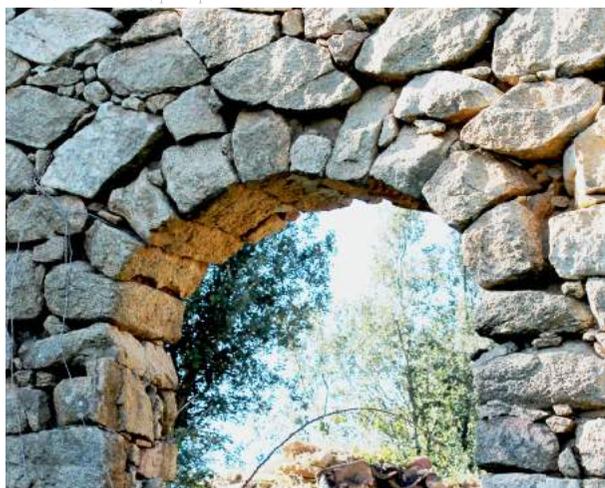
AA Particolare dell'Apertura con Arco Lapideo. Si nota la geometria dell' arco a sesto ribassato e i conci d'imposta e in chiave. Porta, Edificio 3, prospetto esterno. Foto dell'Autore.
